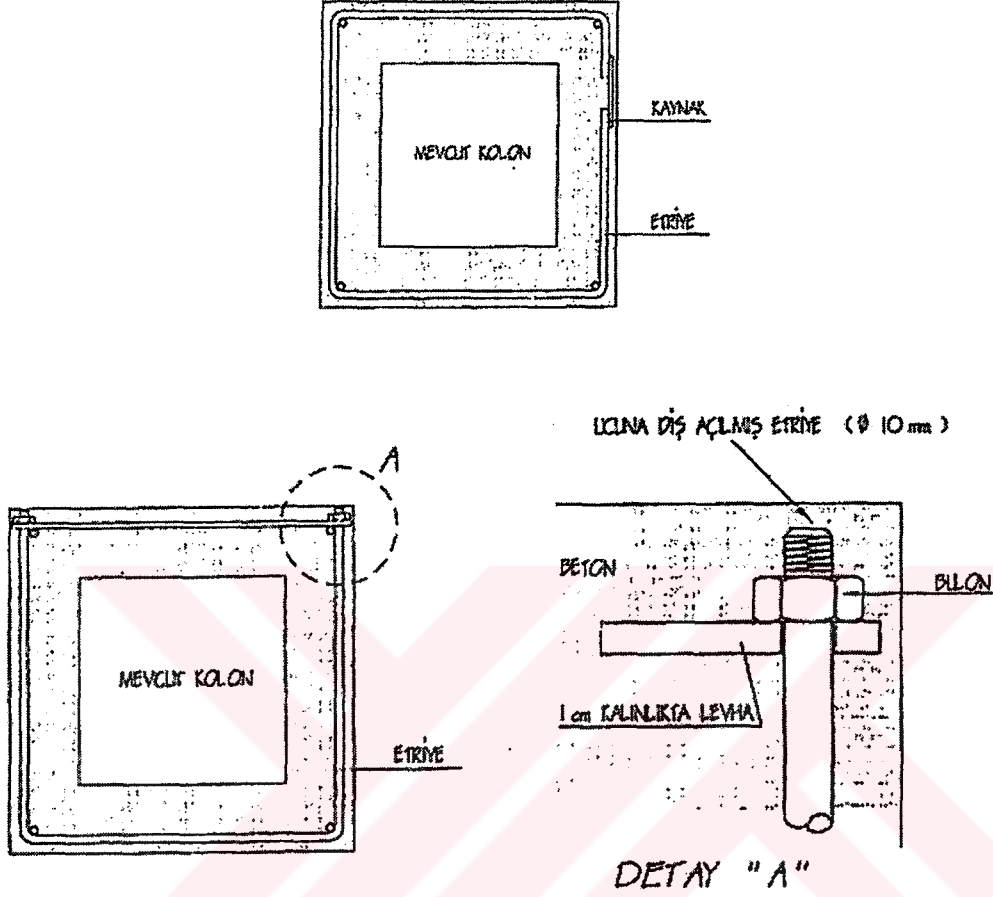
Yeni Eklenen Donatılarının Kolon Üst Başında Ankrajı
